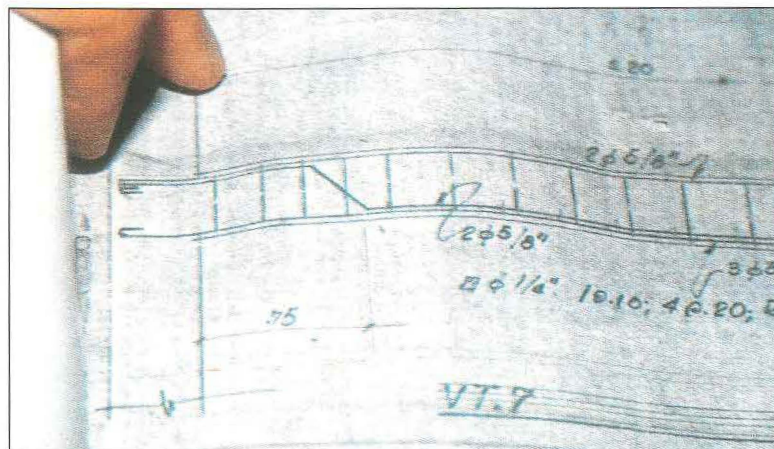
Detalle del Refuerzo en una viga del Hospital Carlos Alberto Segúin de Arequipa. Note los escasos estribos y el doblado del fierro.
